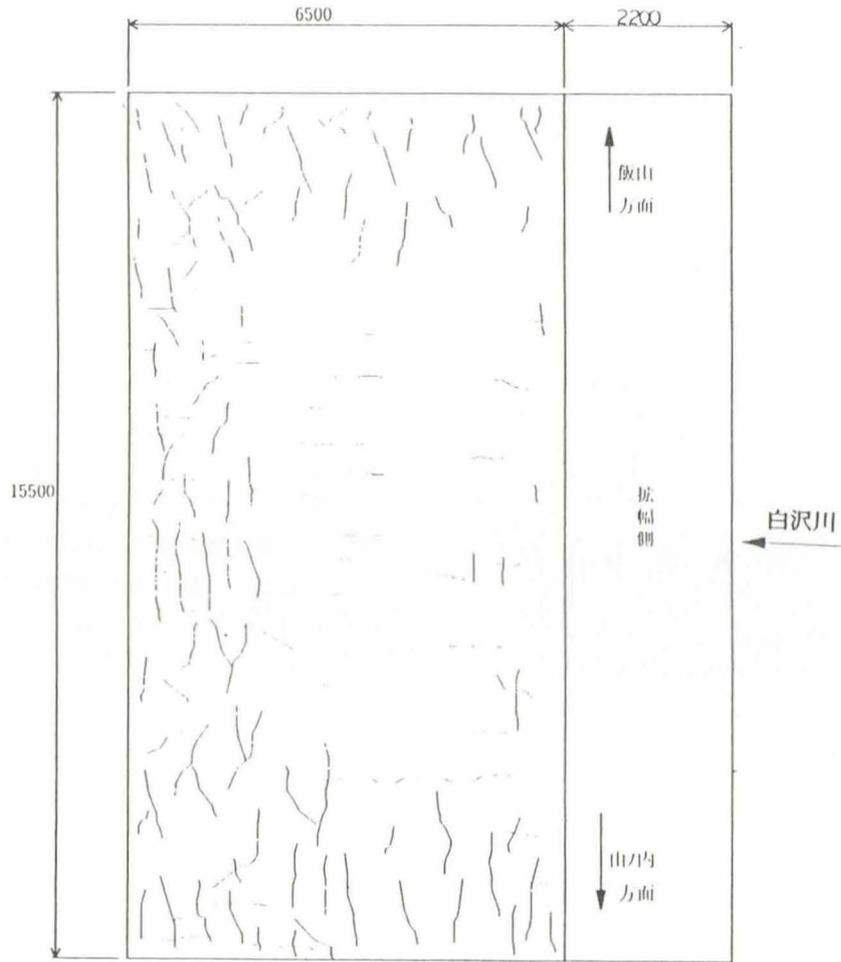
底面ひび割れ状況図 (中央径間底面)
